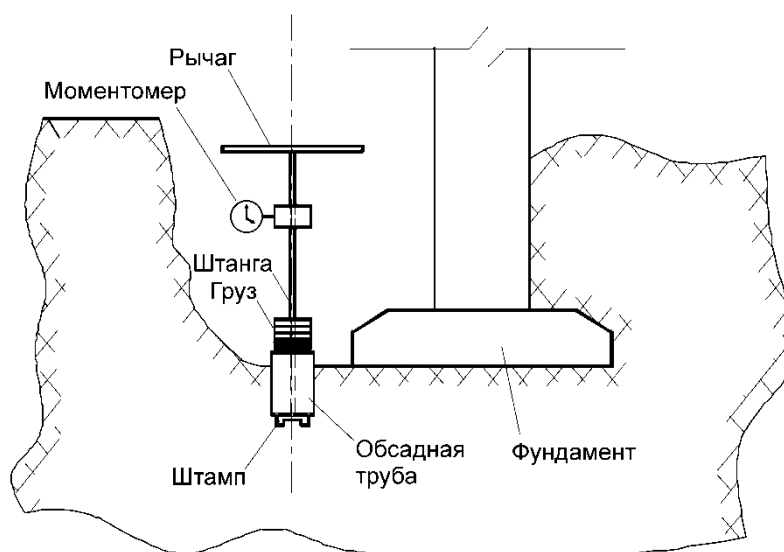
Схема испытаний в шурфе: 1 – обследуемый фундамент; 2 – кольцевая нагрузка; 3 – обсадная труба; 4 – грузовая платформа; 5 – грузы; 6 – штанга; 7 – моментомер; 8 – рычаг приложения кольцевой нагрузки (Кубецкий, 1979)
